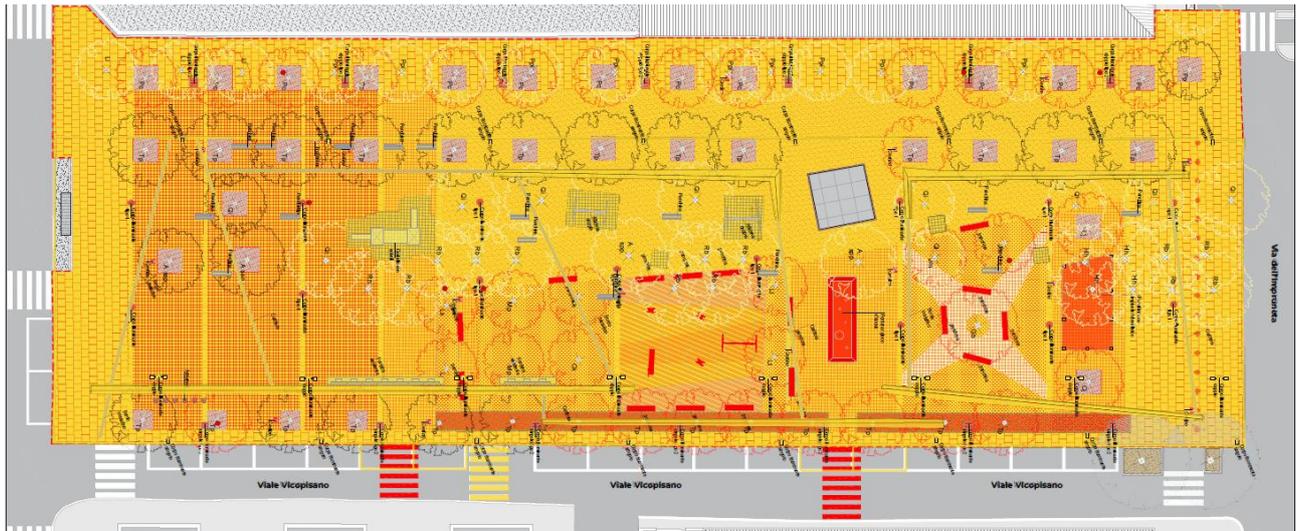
Estratto dall'elaborato T.05 – Planimetria stato sovrapposto
